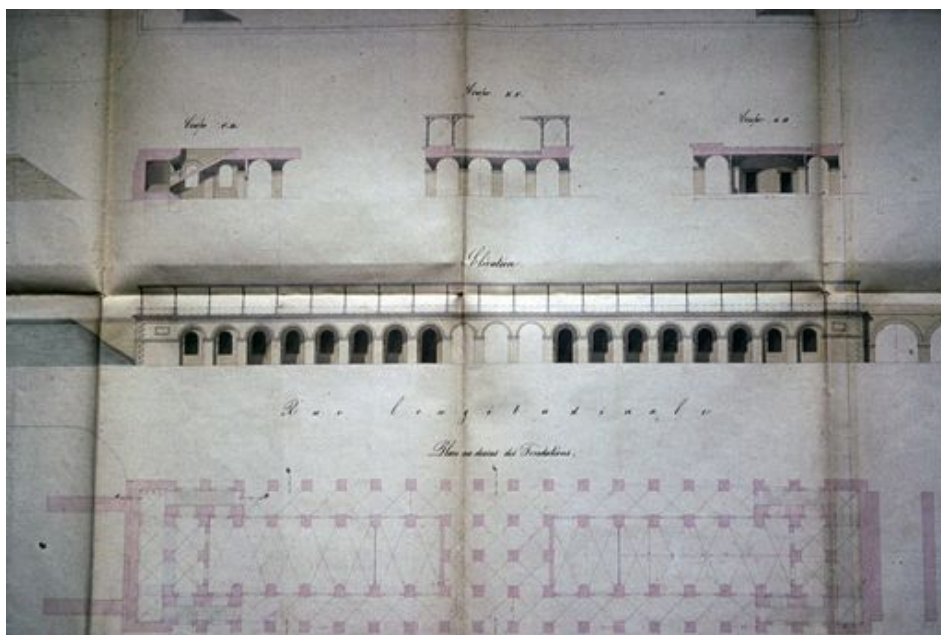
Plan, élévation et coupes de l'embarcadère initial – (ADG)
